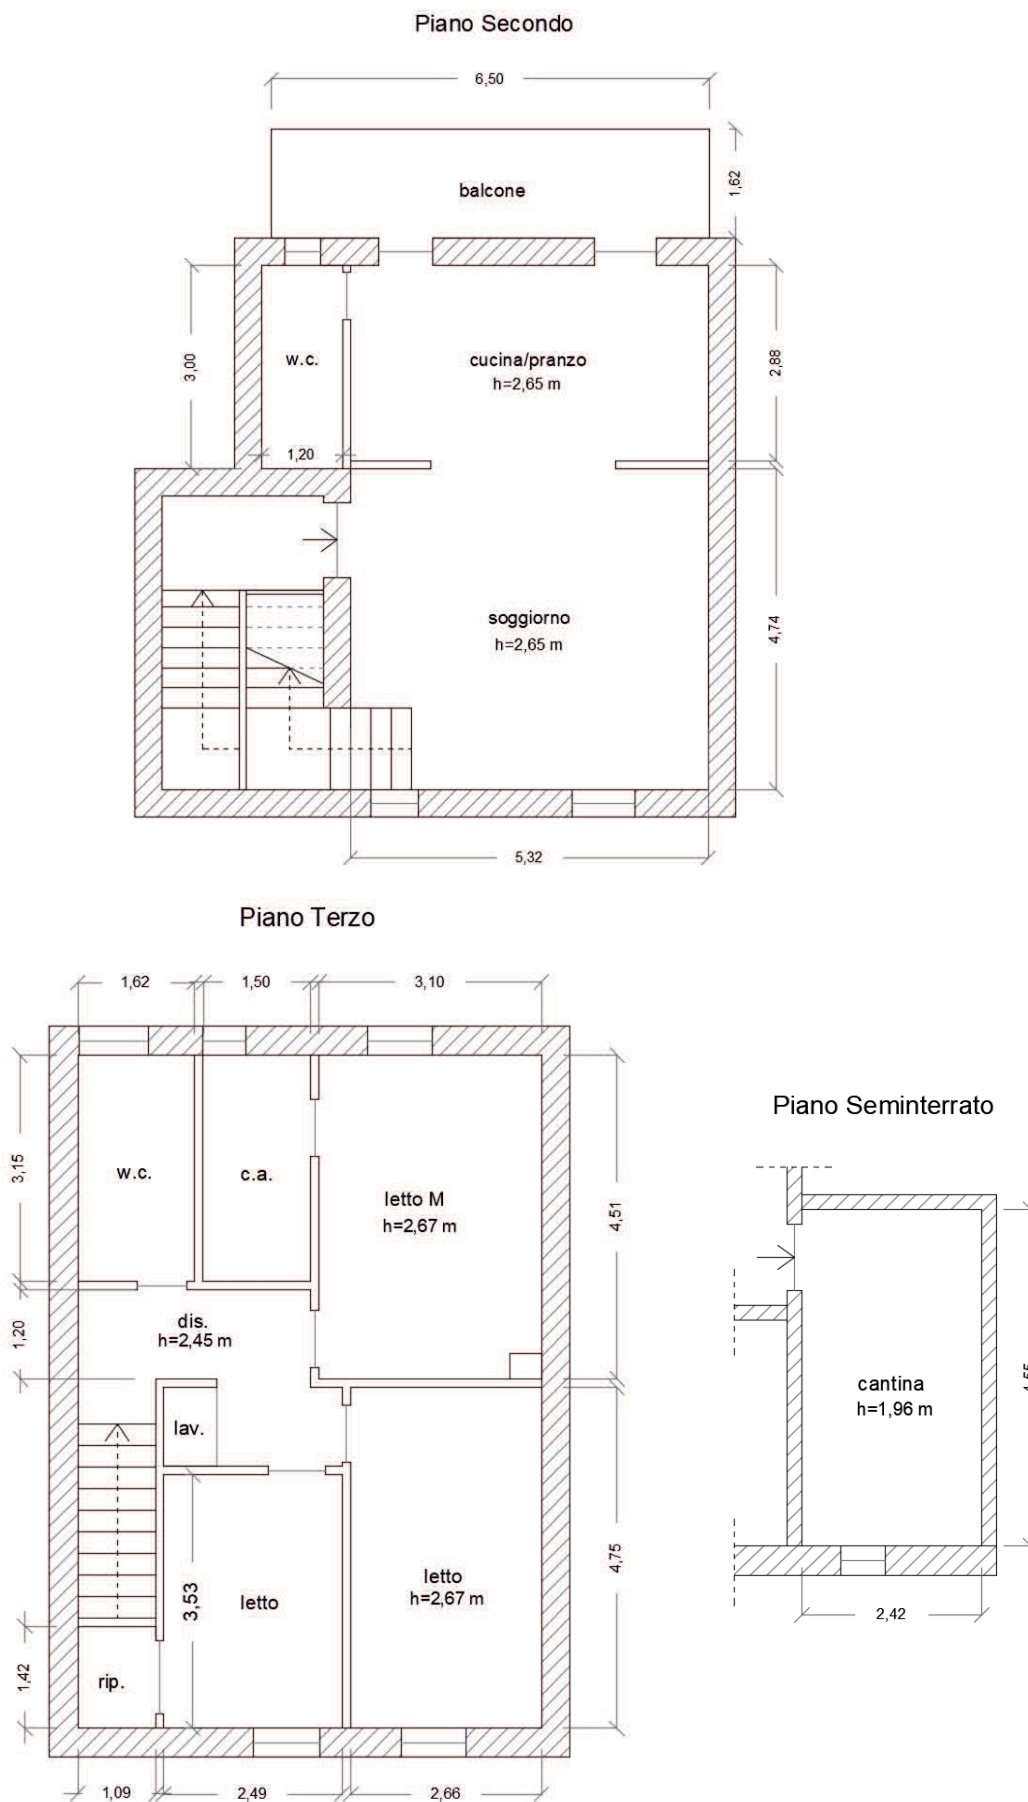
Planimetrie dell'appartamento (sub 23) e della cantinola (sub 24)
